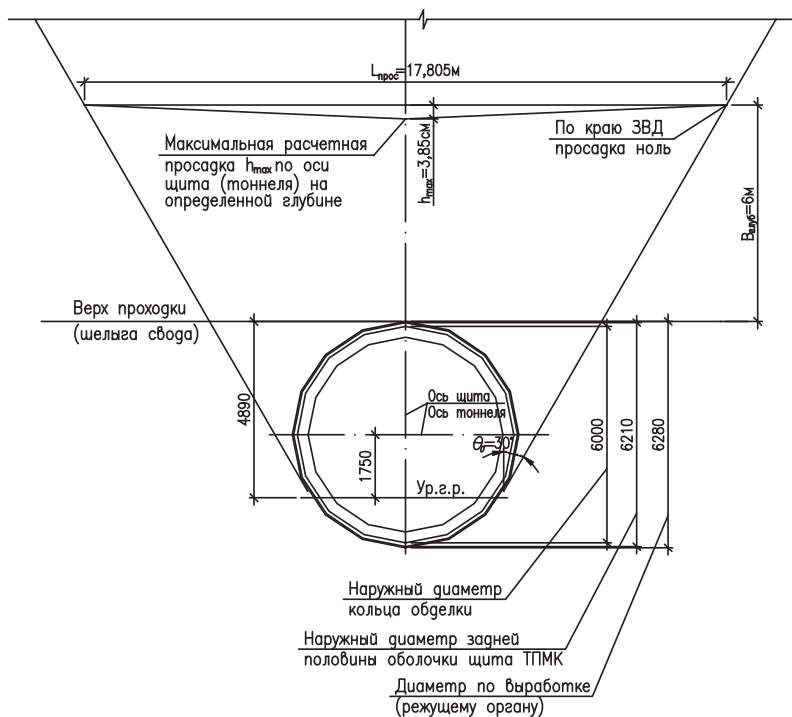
Возможная расчётная просадка грунта на глубине 6 м
